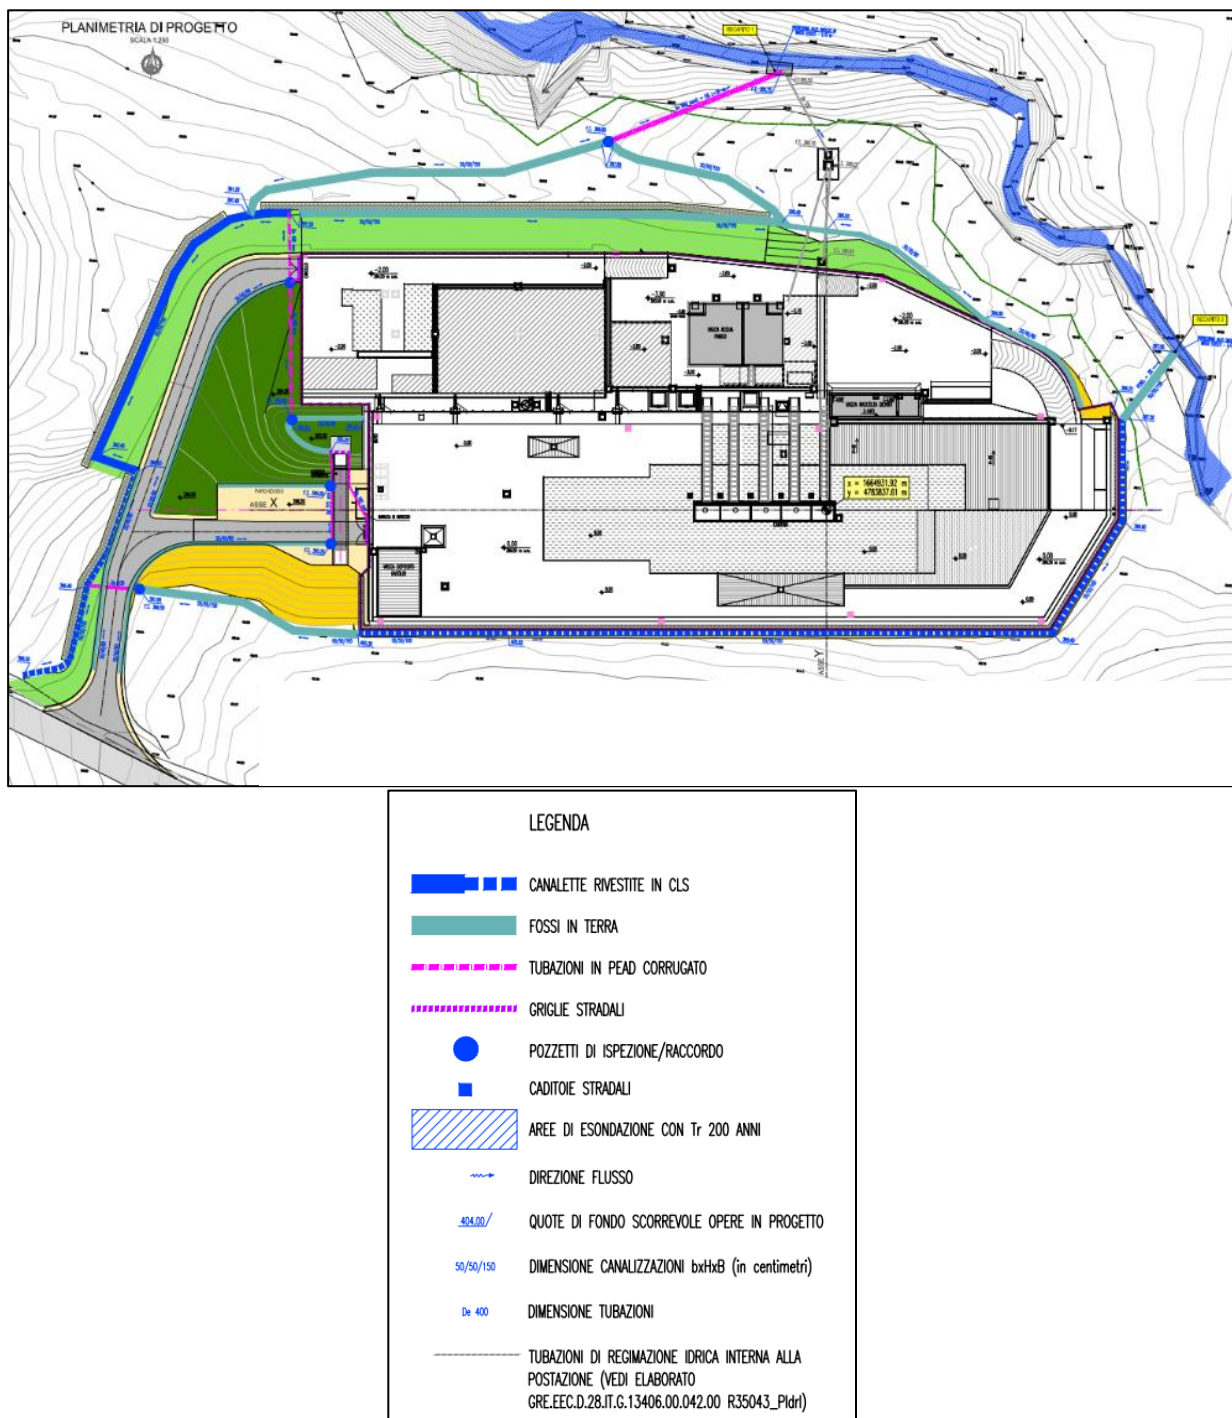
Planimetria di progetto della rete idraulica di intercettazione ed allontanamento delle acque esterne alla postazione.
